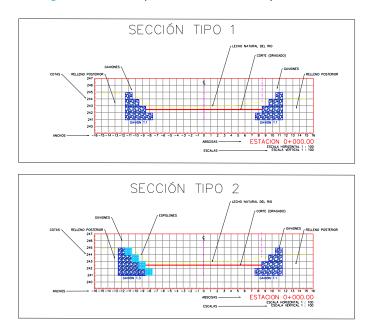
Vista en Sección transversal Propuesto intervención Arroyo Parrantial
